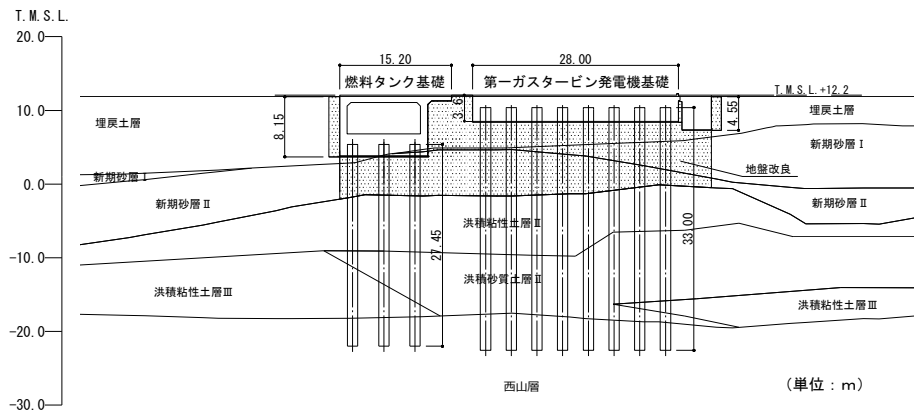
第一ガスタービン発電機基礎及び燃料タンク基礎断面図 (EW 断面)
